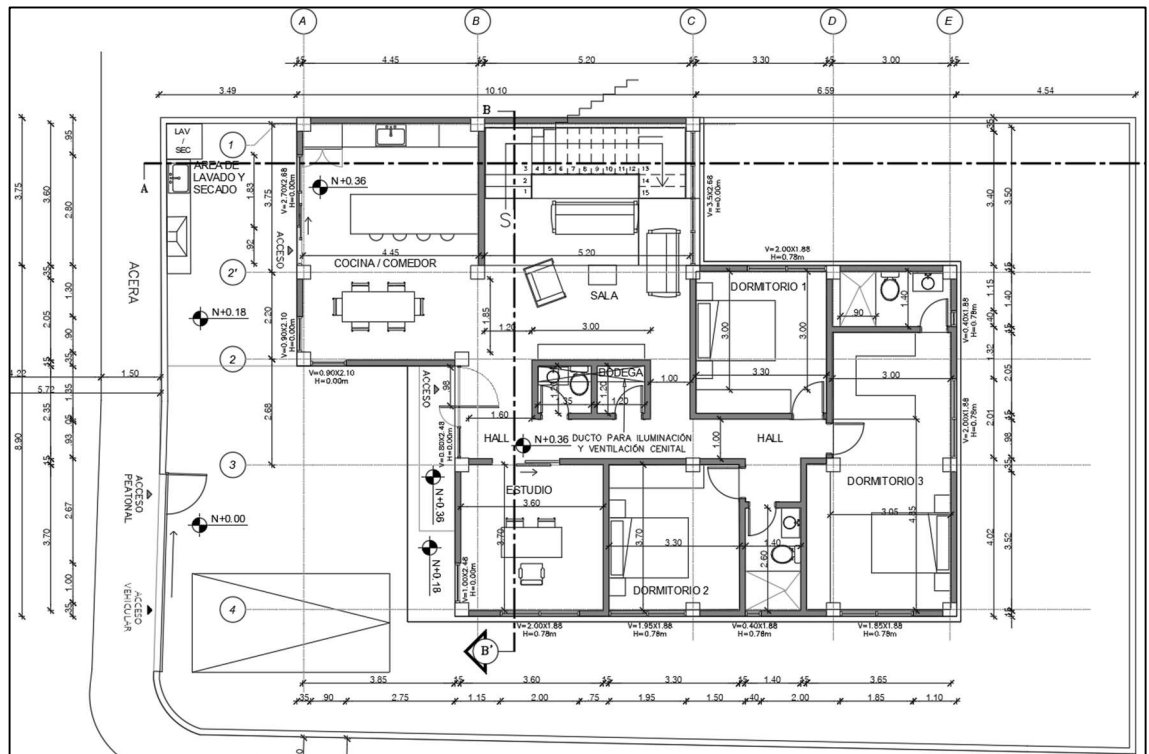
Planta 1 arquitectónica del caso de estudio.
